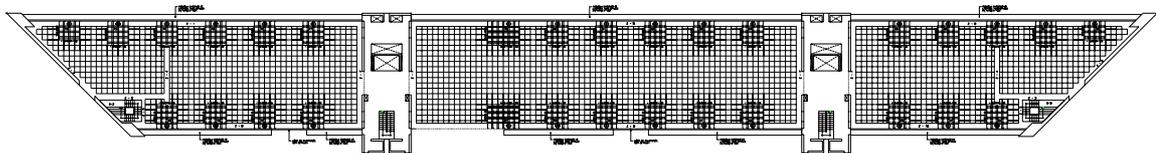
Planta tipo del edificio principal sobre rasante. Solución estructural adoptada.
